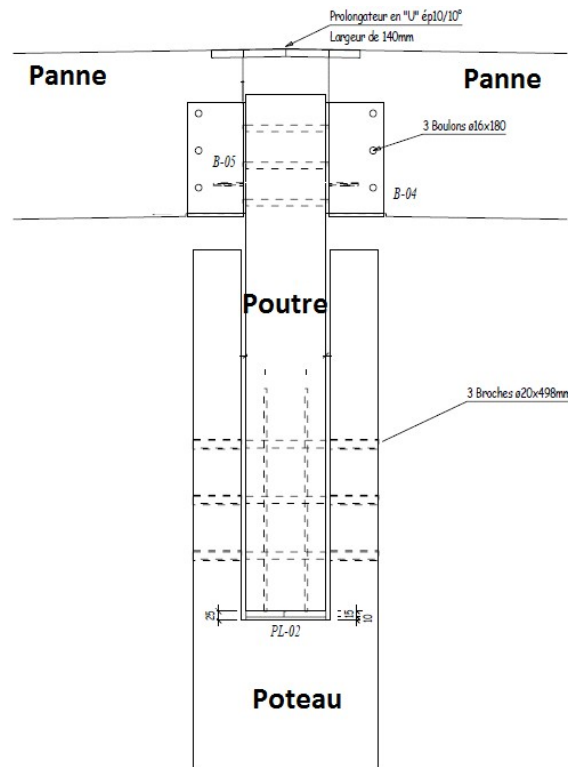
Vue en élévation liaison panne/poutre/poteau
